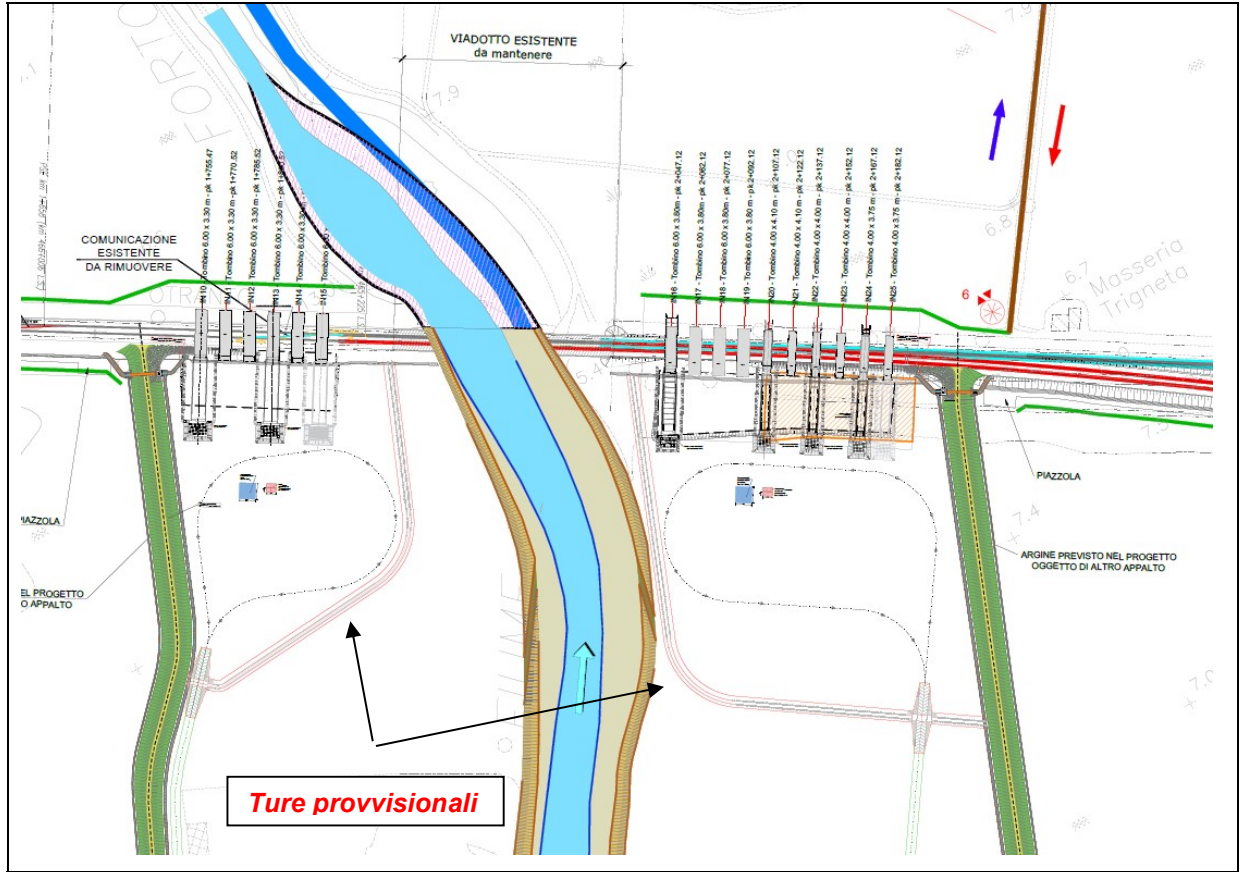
Planimetria ture provvisionali in alveo Fortore
